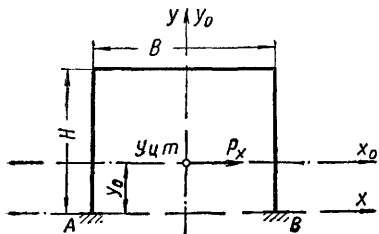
П-образный участок трубопровода со сварными отводами без прилегающих плеч
